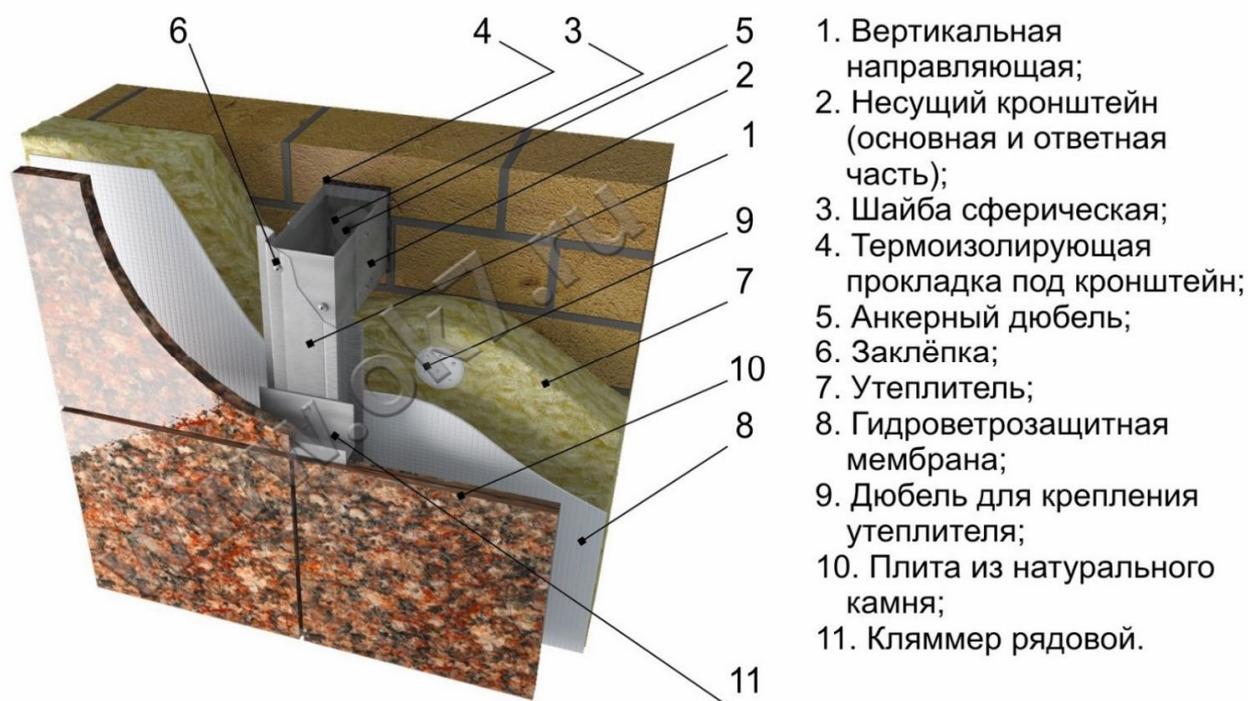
Фасадные системы с вентилируемым воздушным зазором «РУСЭЖСП» для облицовки натуральным камнем
